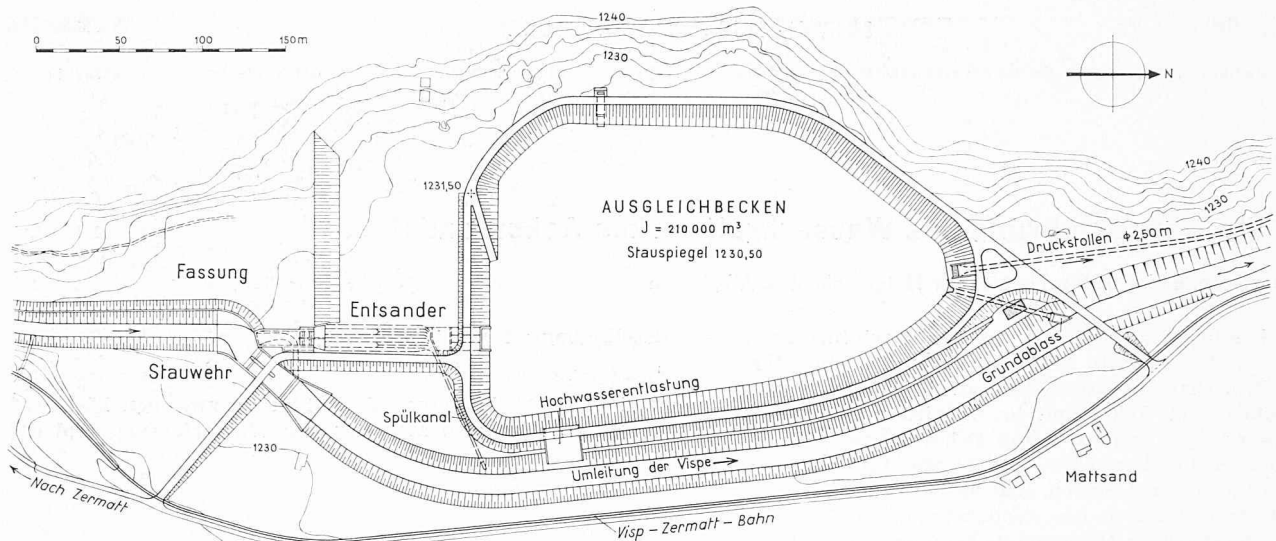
Kraftwerk Ackersand II, Ausgleichbecken Mattsand, Lageplan 1:4500
